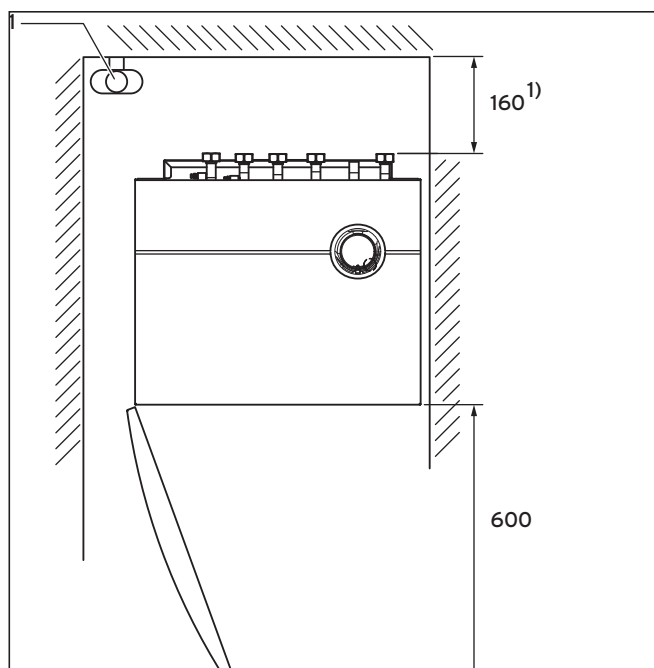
Espaces lors de l'installation (valeurs en mm)
